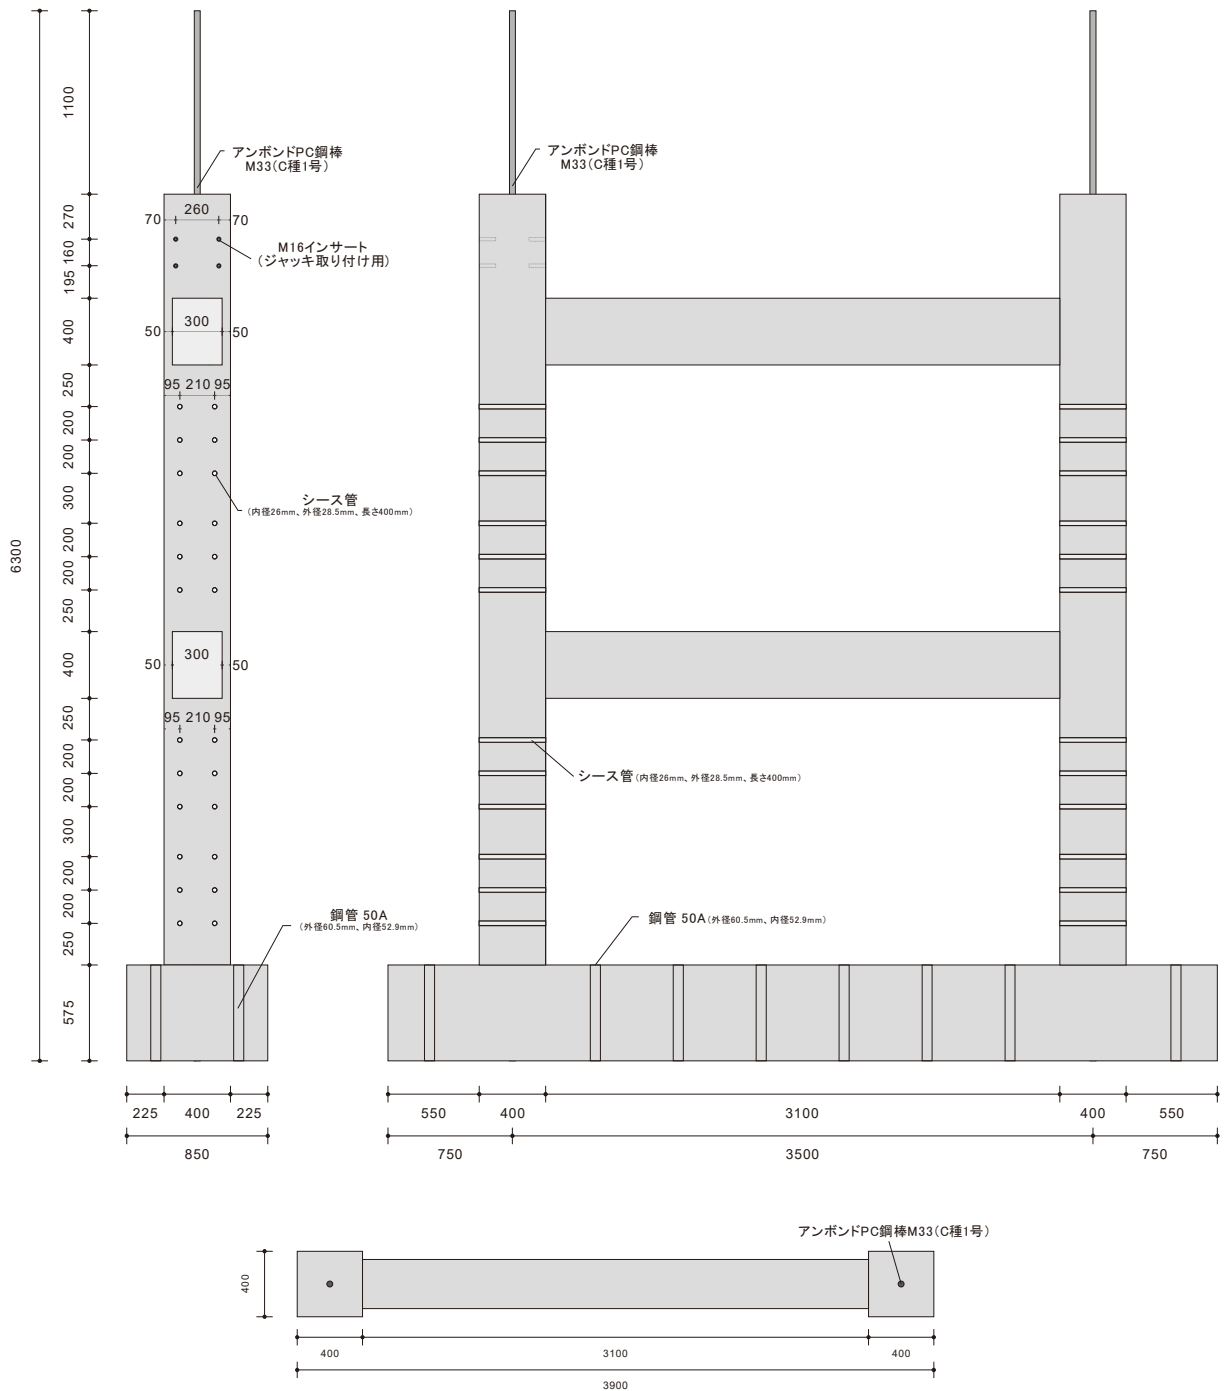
試験体 WB の RC 部分の寸法図 (単位:mm)
